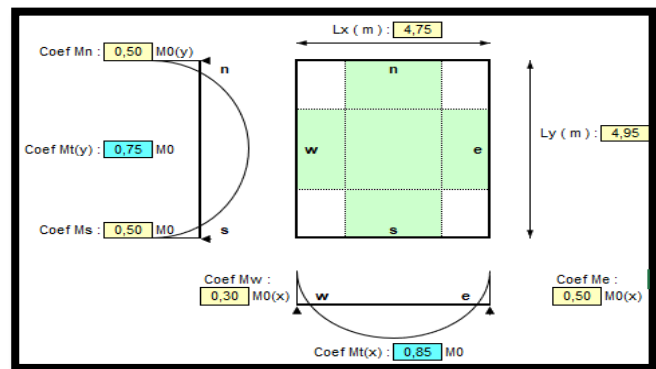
Schéma de calcul de la dalle pleine du sous-sol.
